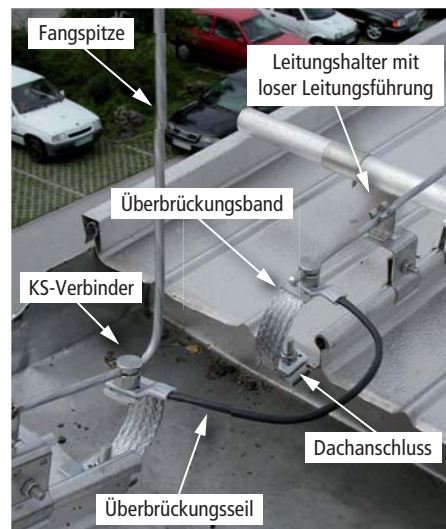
Leitungshalter für Metalldach-Rundstehfalz
